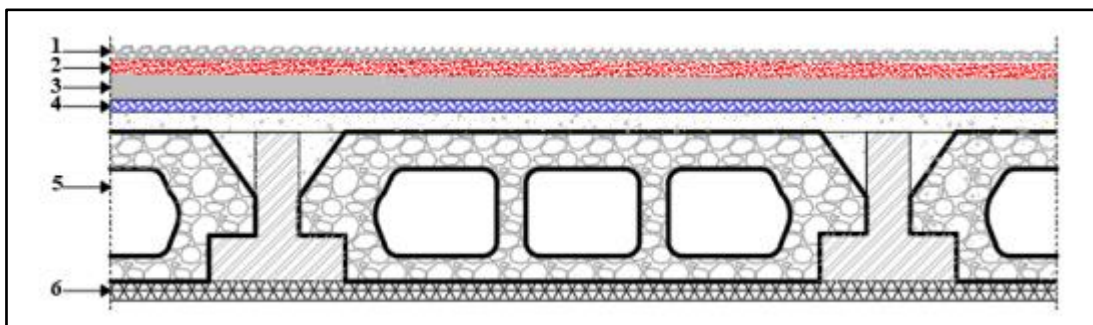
Coupe verticale du plancher terrasse en corps creux
